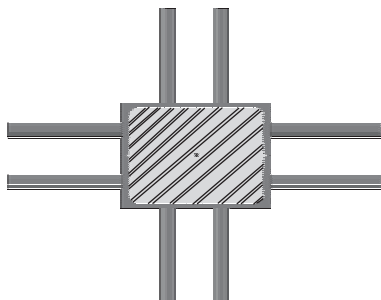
Схема вузла з'єднання монолітного безкапітального безбалкового перекриття із сталезалізобетонними колонами зі швелерів
